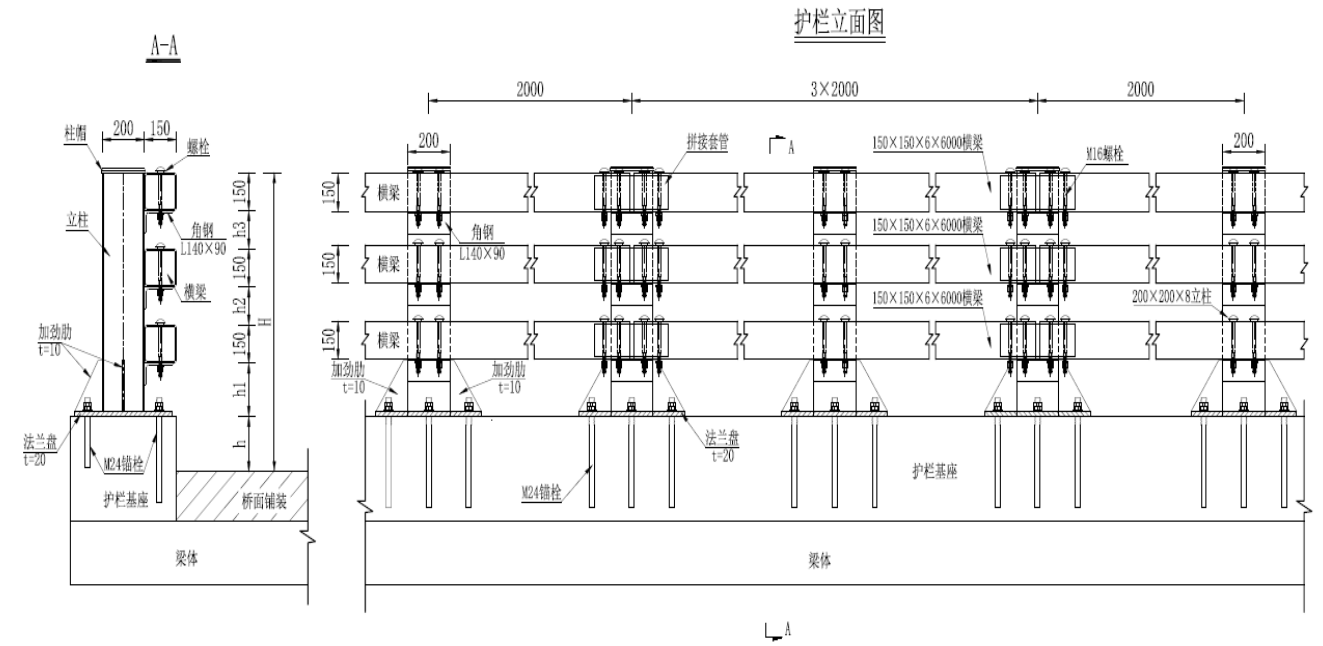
金属梁柱式护栏构造示意图 (单位: mm)
